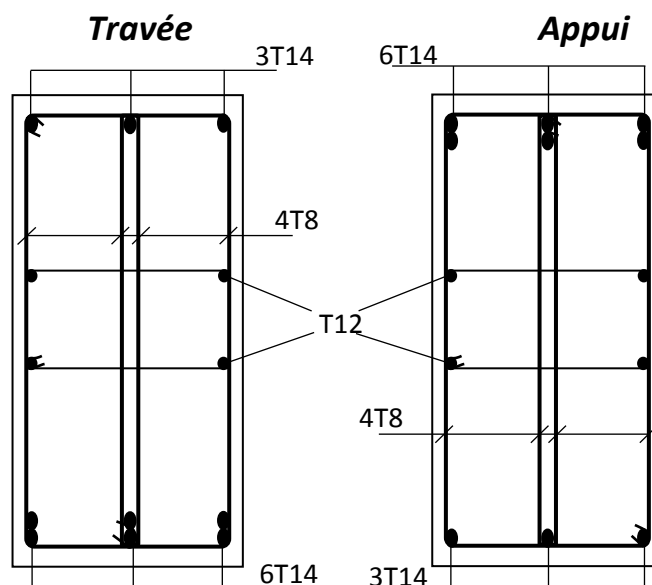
Schéma de Ferrailage des Poutres principale
